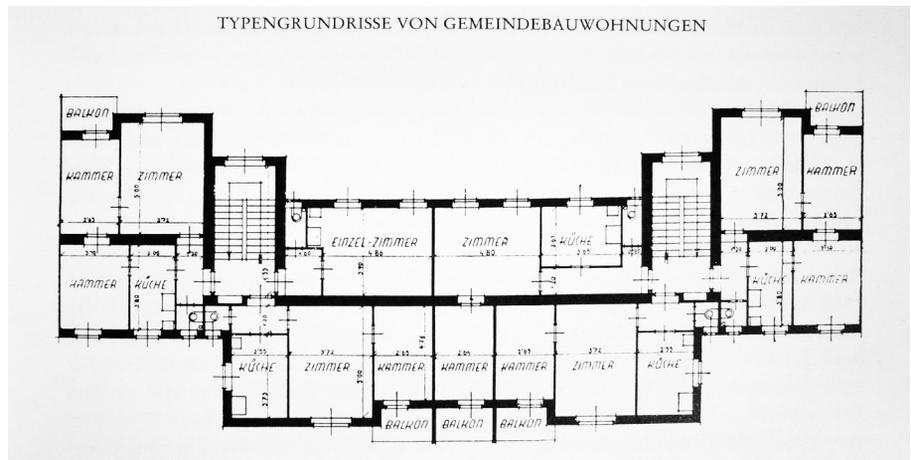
Das Rote Wien, Typengrundriss von Gemeindewohnbauten
